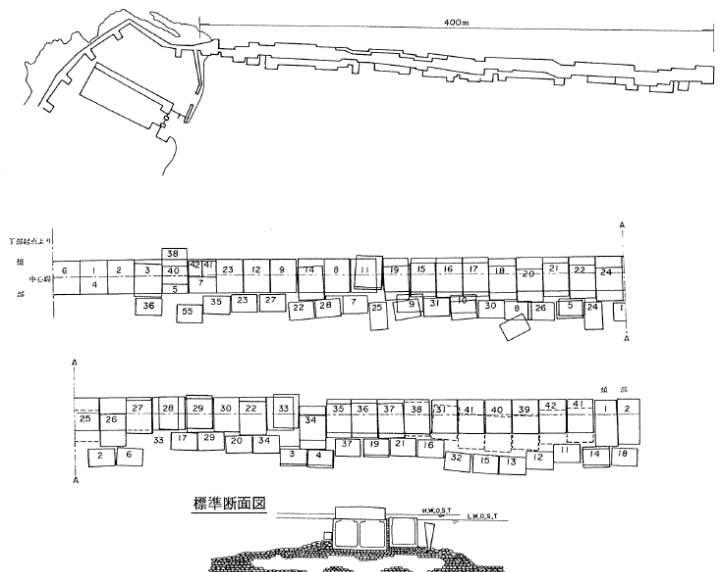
北防波堤ケーソン移動状況図と復旧標準断面図
